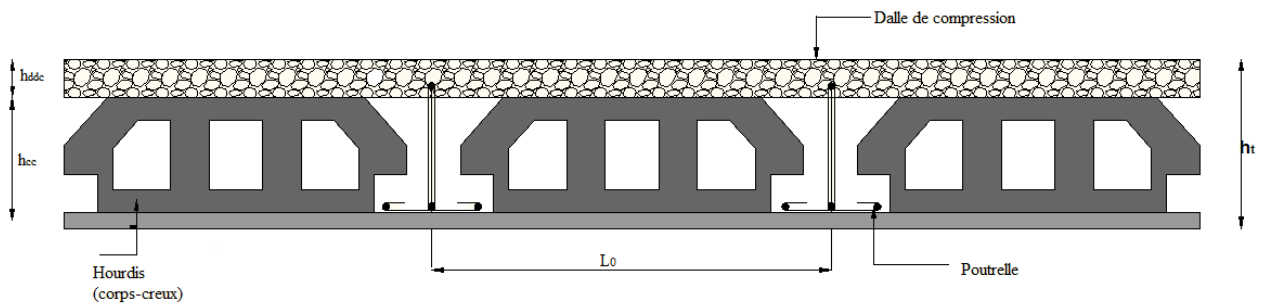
Coupe transversale d'un plancher à corps creux.
